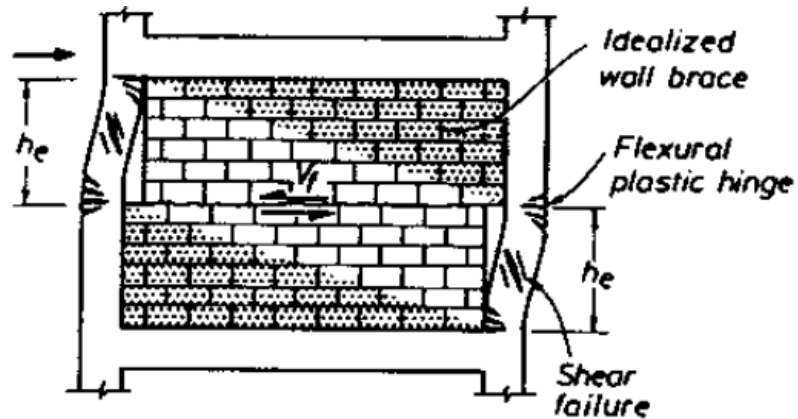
Mecanismo de fallas muro de albañilería y columnas de concreto.
